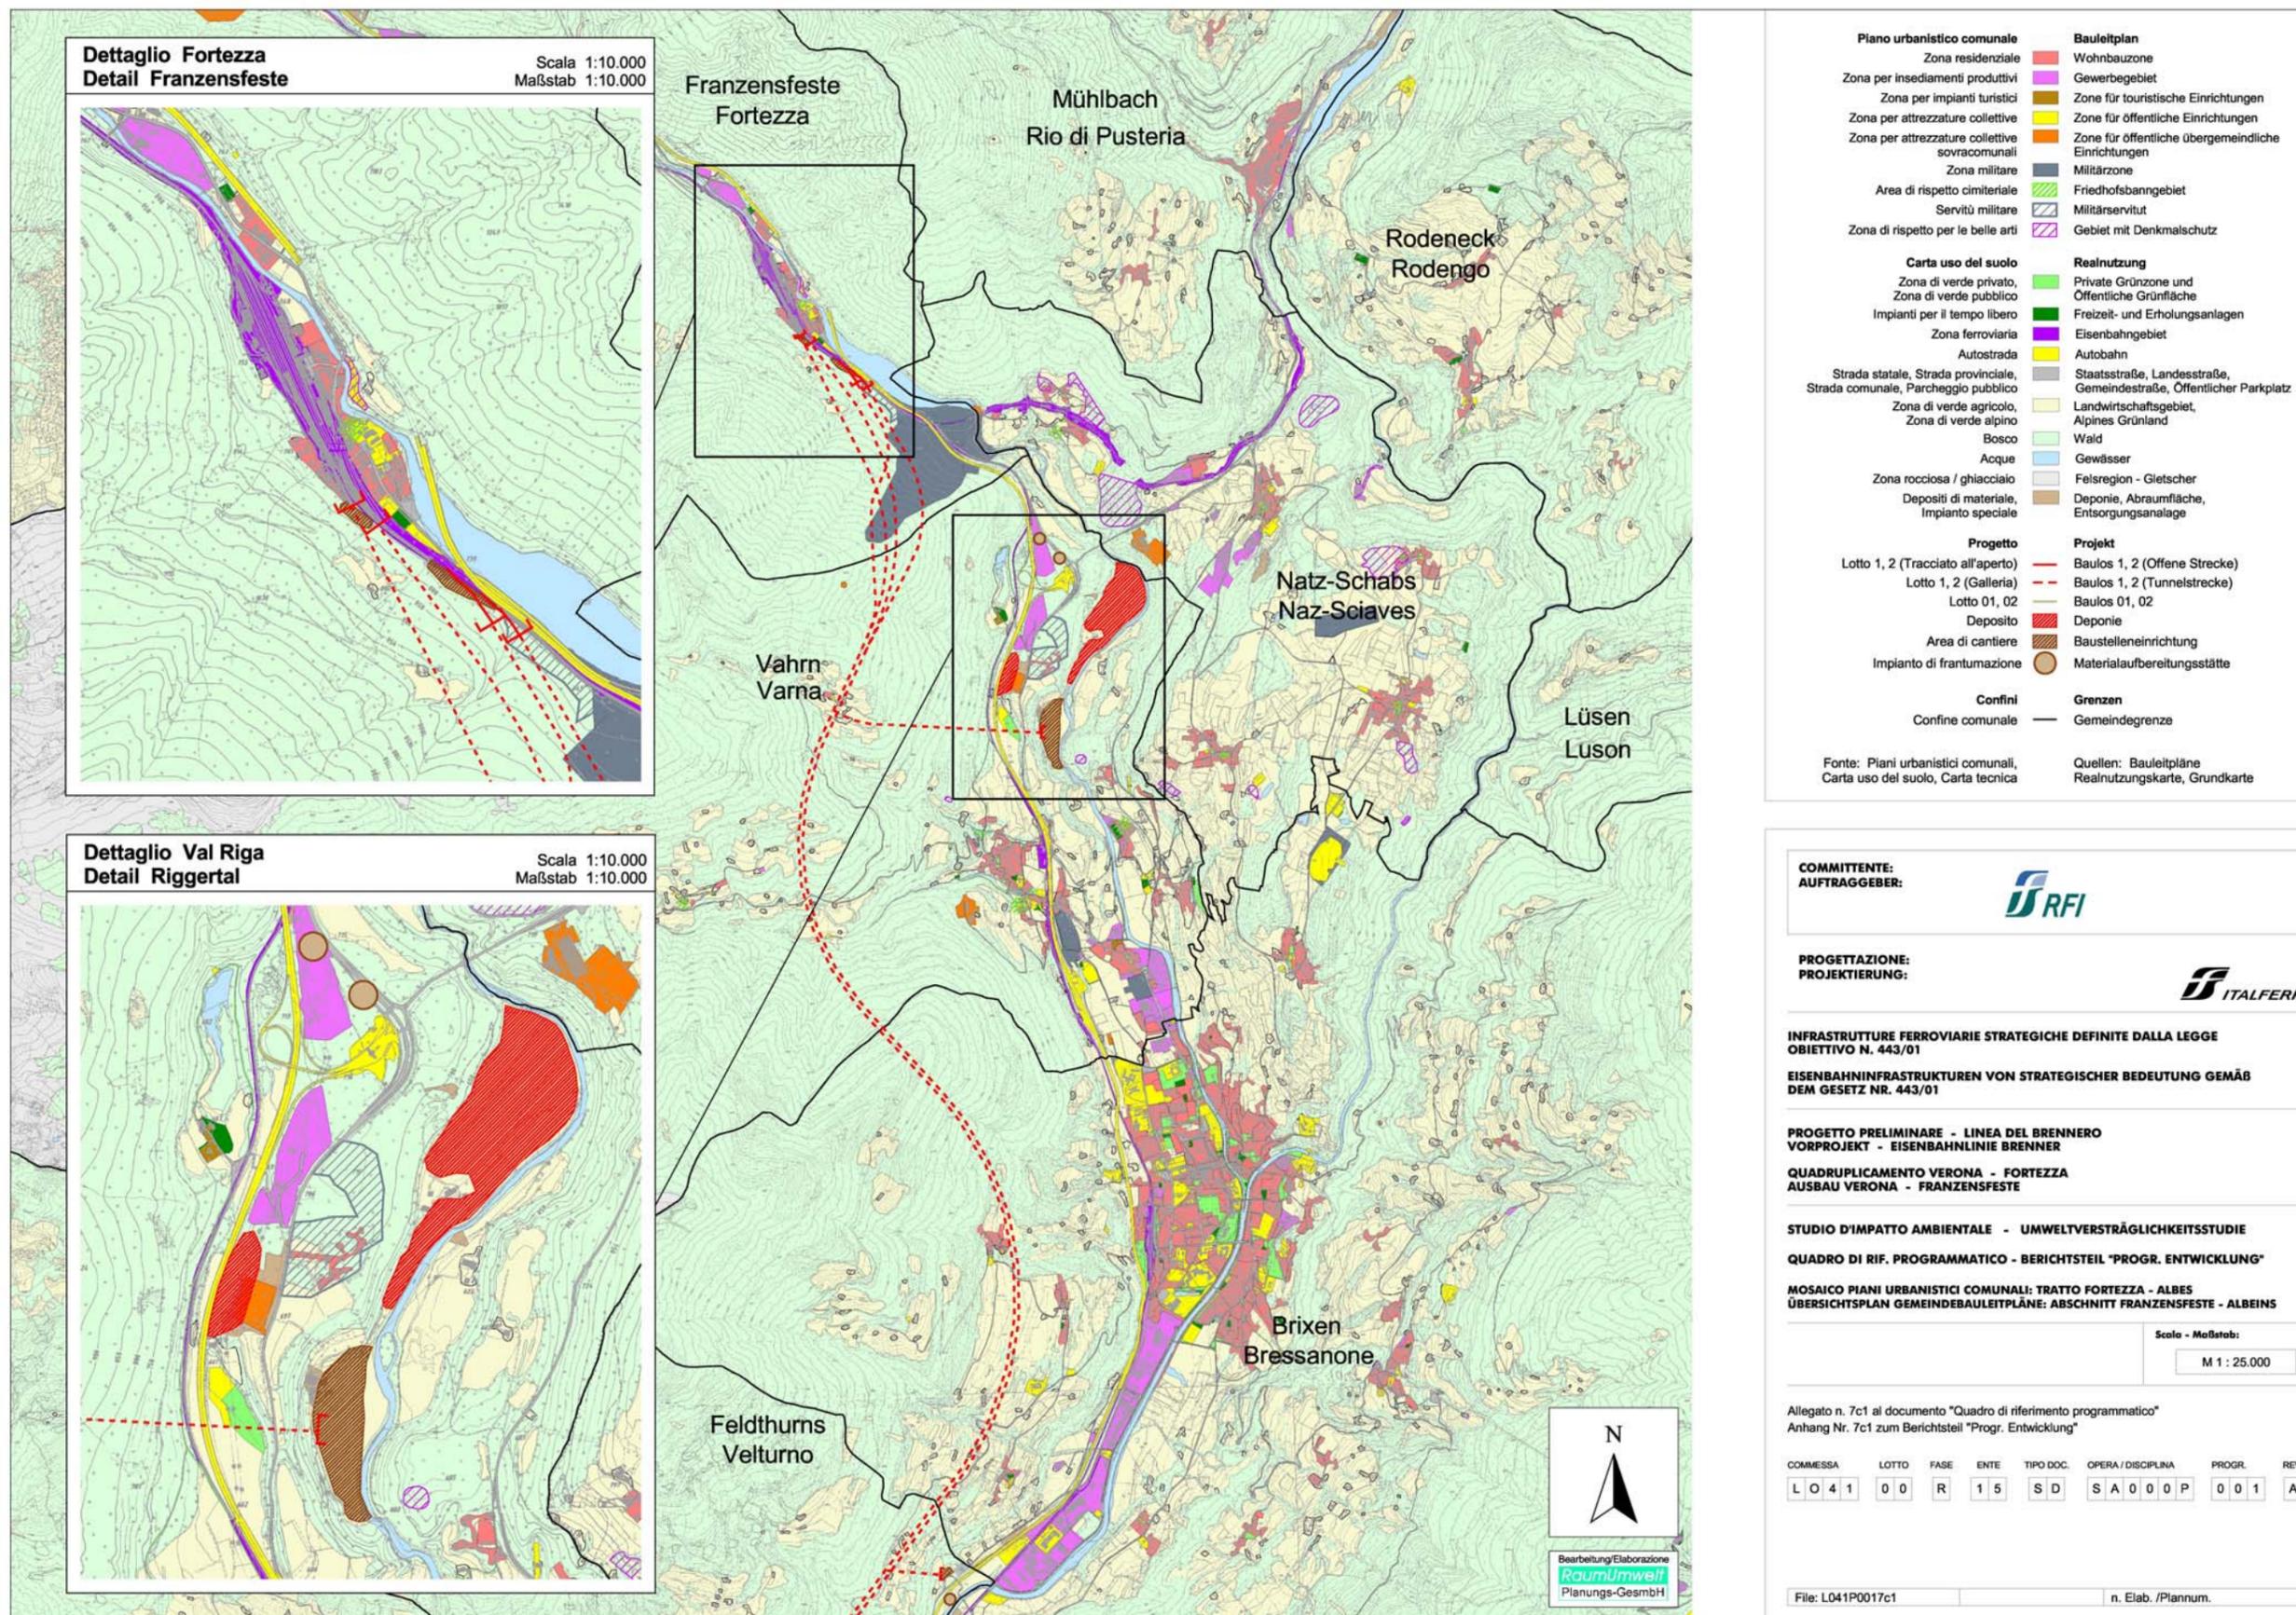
Tracciato, depositi e aree di cantiere nel tratto tra Fortezza e Bressanone (Lotto prioritario I).
